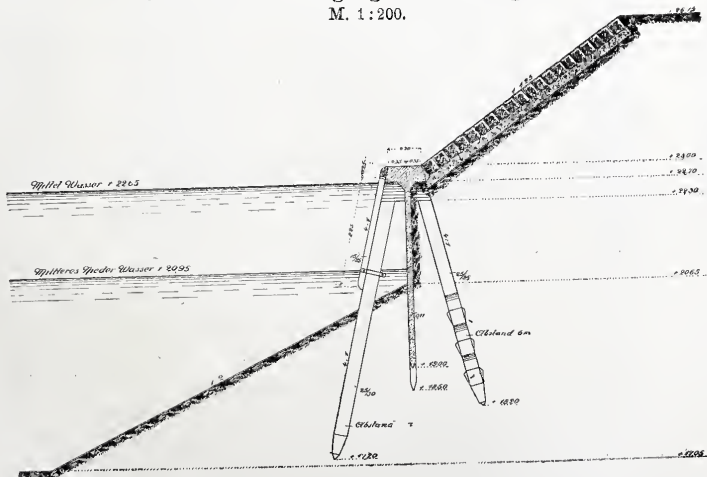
Querschnitt durch die Eisenbeton-Uferbefestigung.
